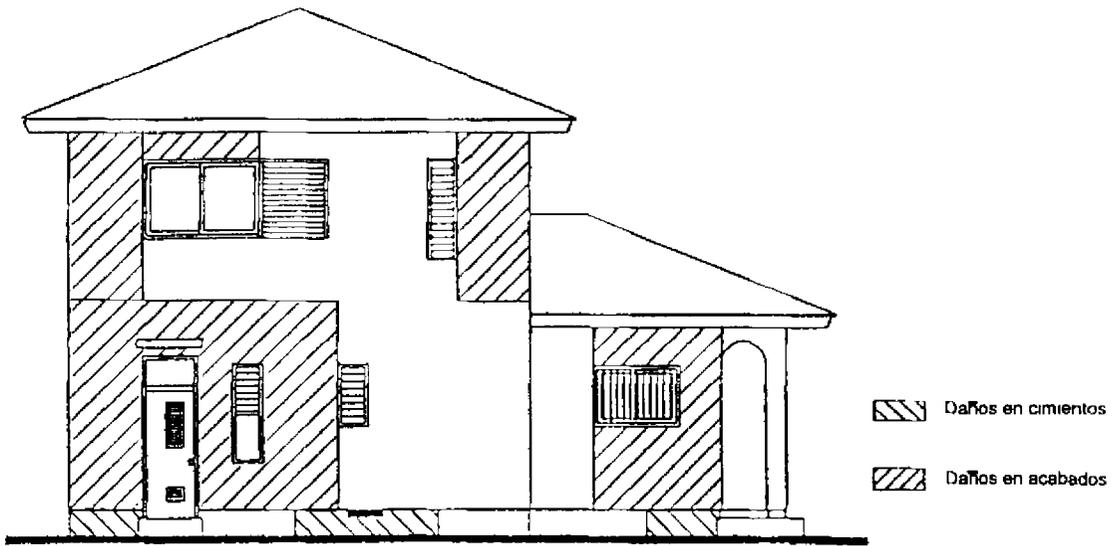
Distribución de Elementos Dañados en la Elevación Norte
